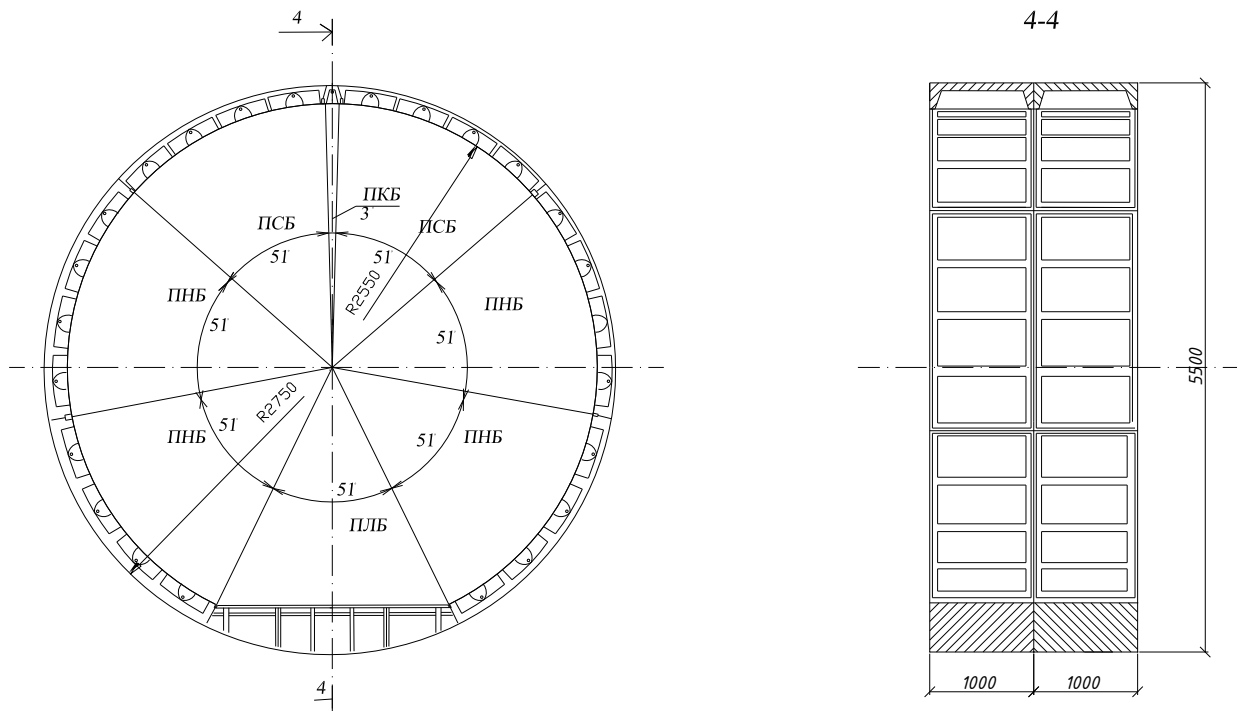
Варіант №2. Збірна залізобетонна оправа із тюбінгів з плоским лотком
